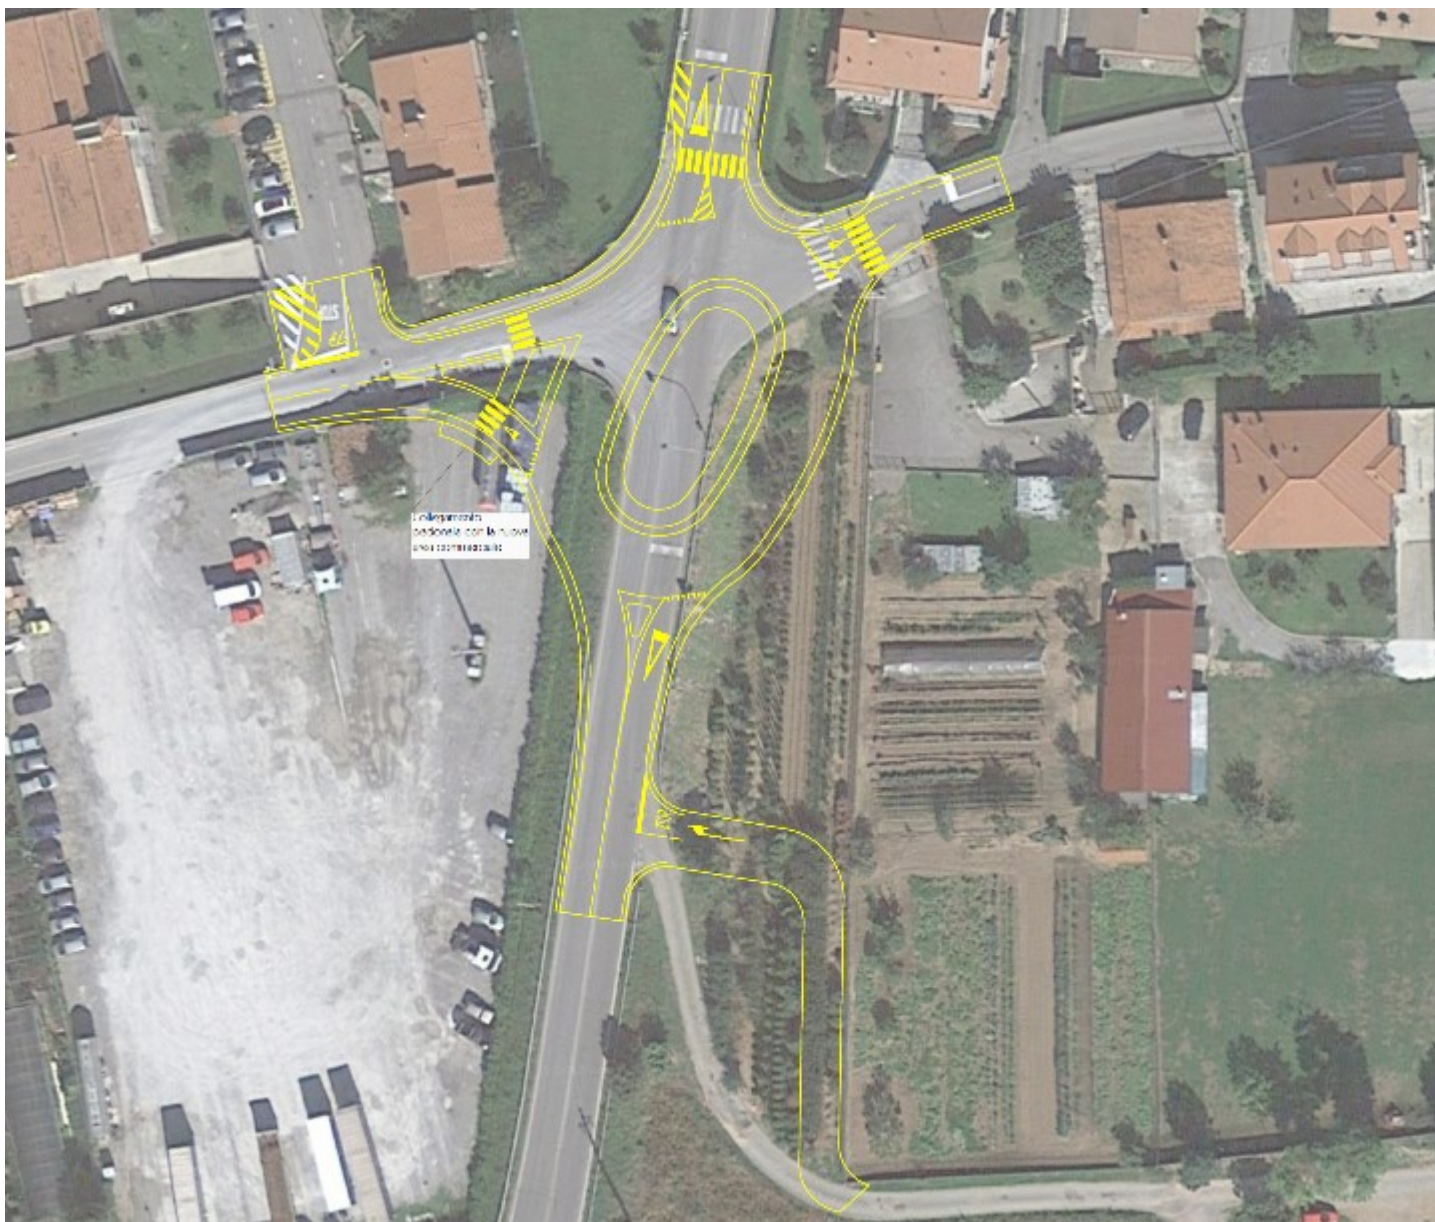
Intersezione SP175 / via Romanelle – Sovrapposizione su fotopiano
